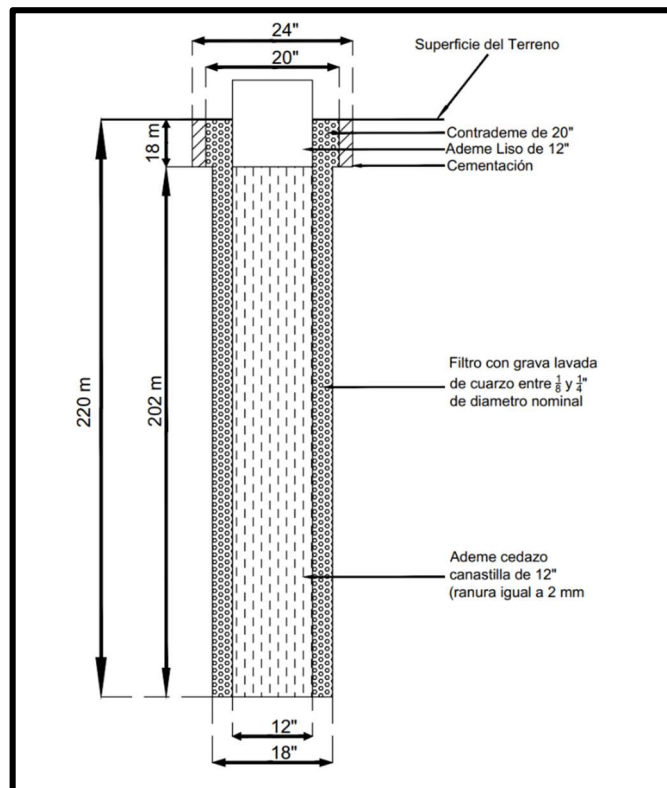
Propuesta constructiva para la perforación de un nuevo pozo.
